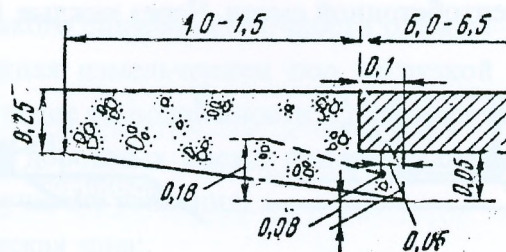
Схема уширения цементобетонного покрытия.
